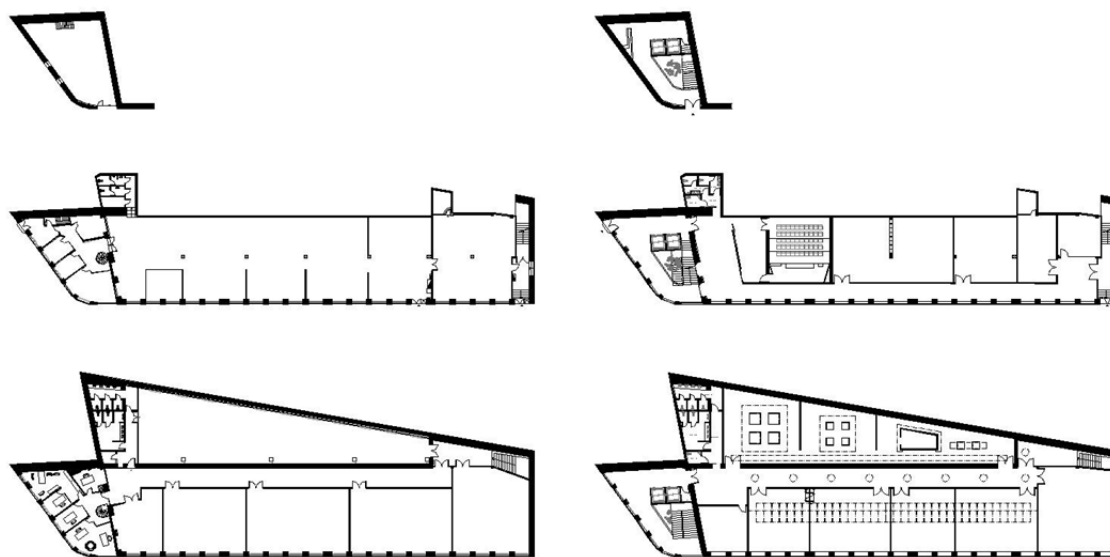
Plantas do Levantamento e Projecto de Reabilitação, Pisos 0, 1, 2.
